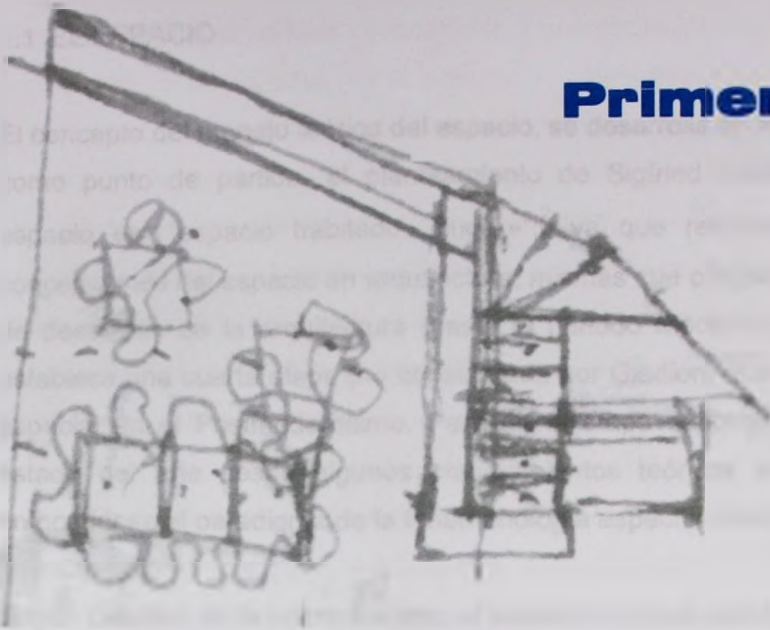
Croquis (Abril 2001) de la planta arquitectónica baja. Módulo de oficina. Obra Medina 2001.
